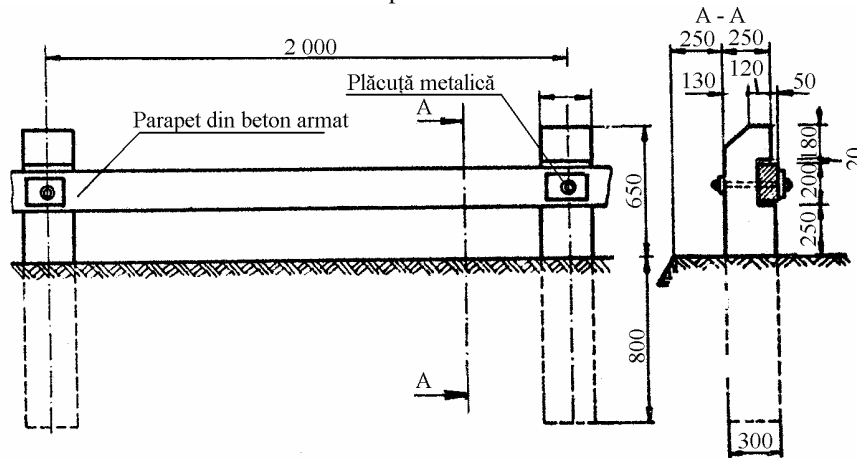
Parapet rigid de tip ușor din beton armat.
